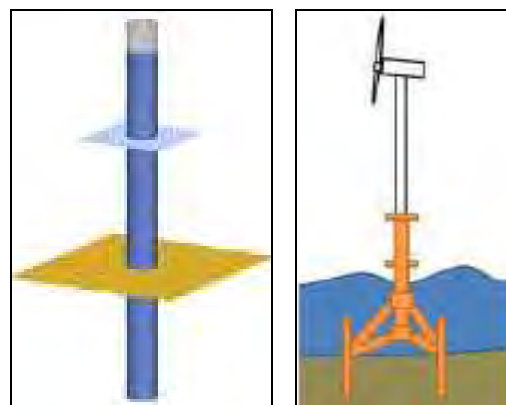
Exemple de fondation par monopieux (gauche) ou multi-pieux (droite)
